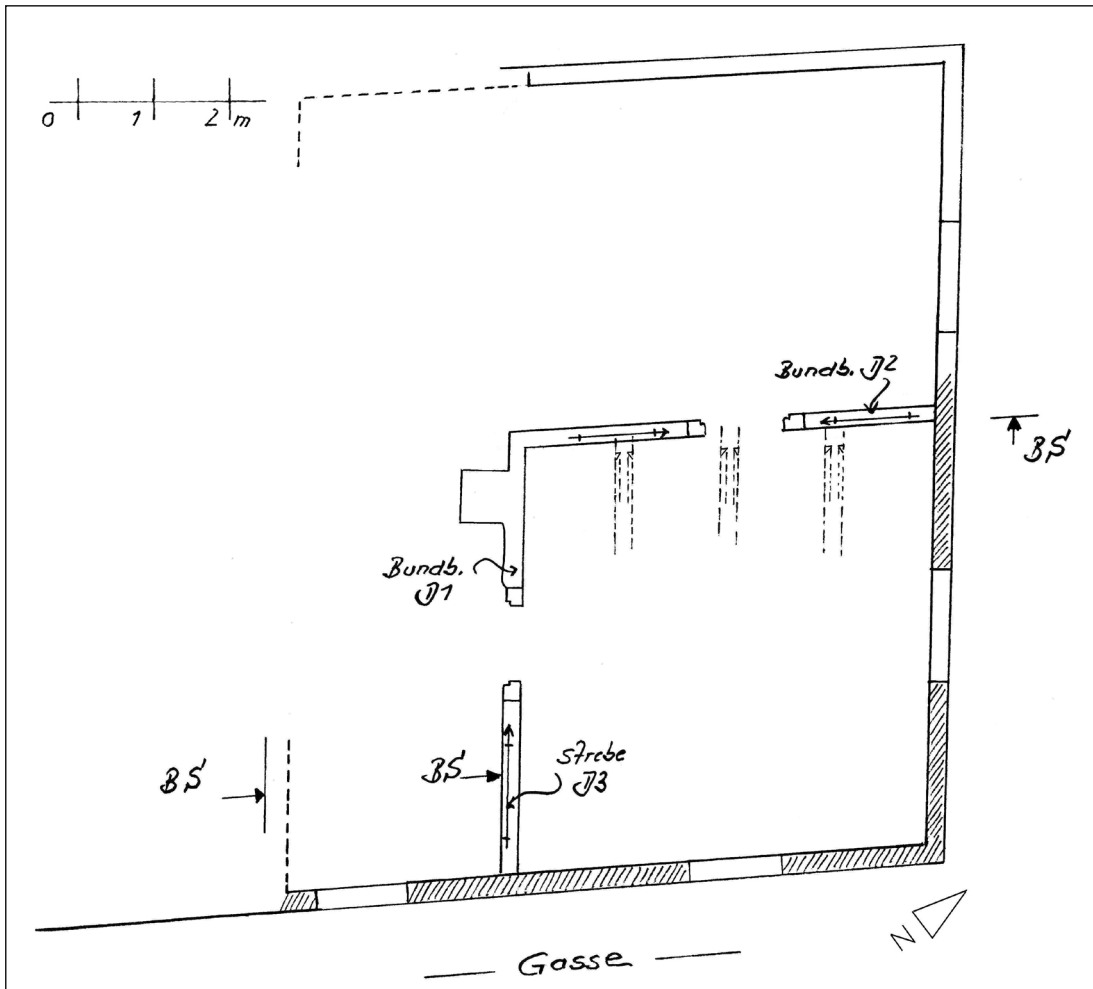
St. Johannesgasse 7, Grundriss 1. Obergeschoss, 1626(d).
